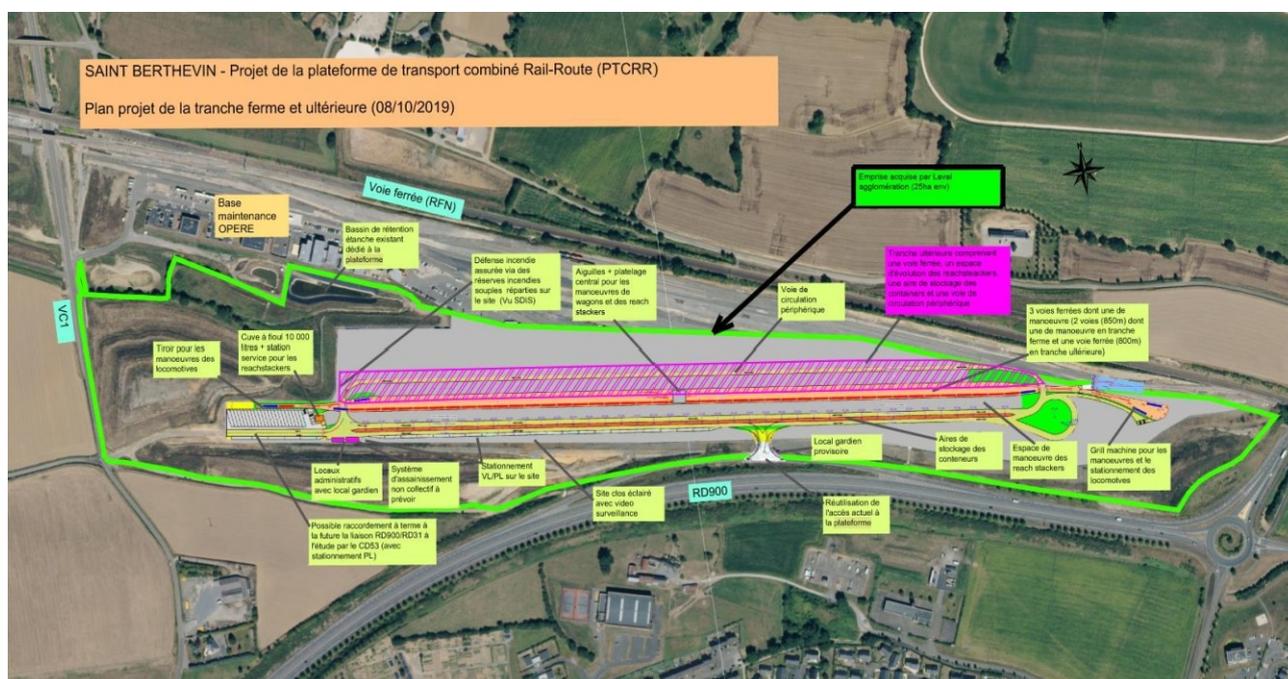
Plan d'aménagement général du projet - Extrait de la notice explicative – pièce A – p.8
